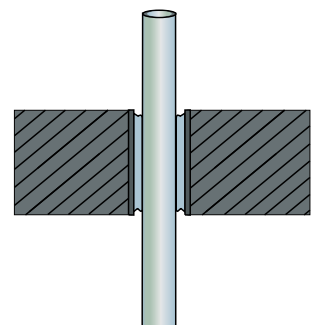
Прохід трубопроводу через будівельну конструкцію
